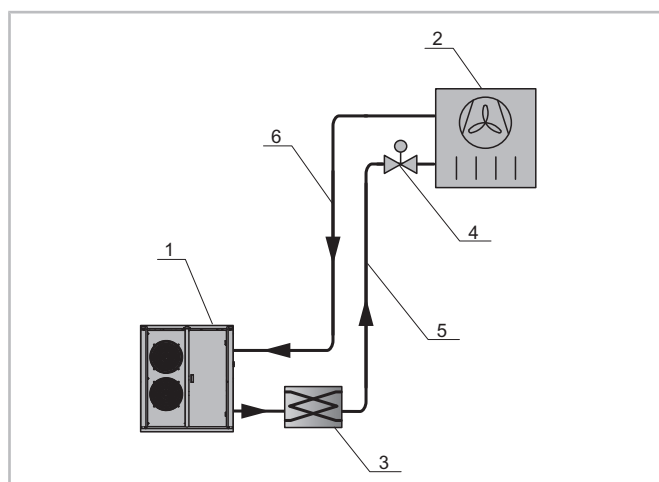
Montaje de la unidad ECOLITE por debajo del evaporador
